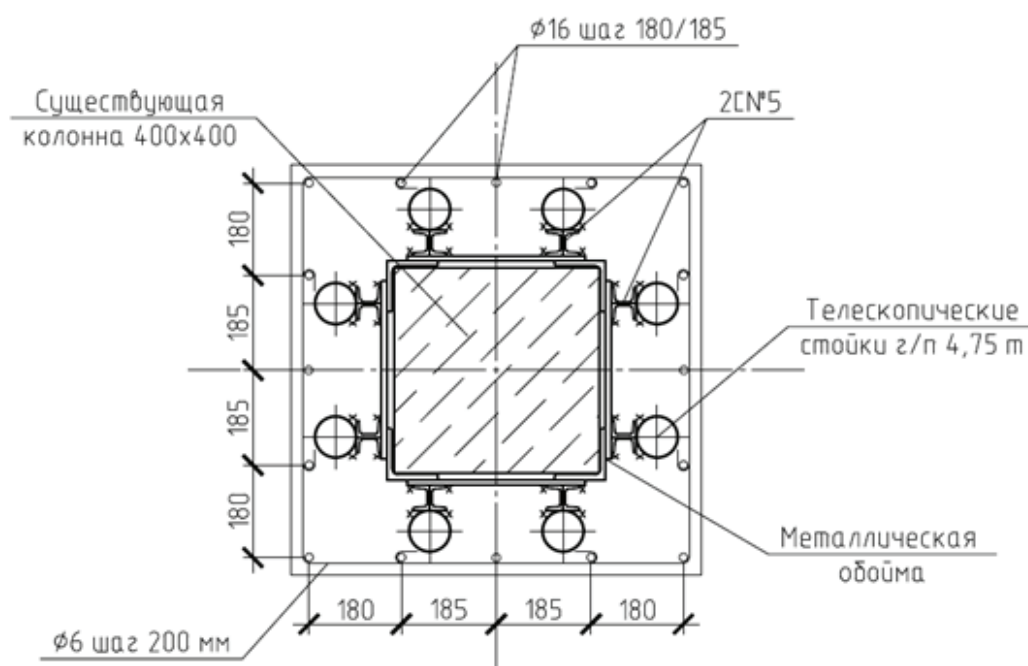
Горизонтальный разрез колонны с установленными стойками и армированием
